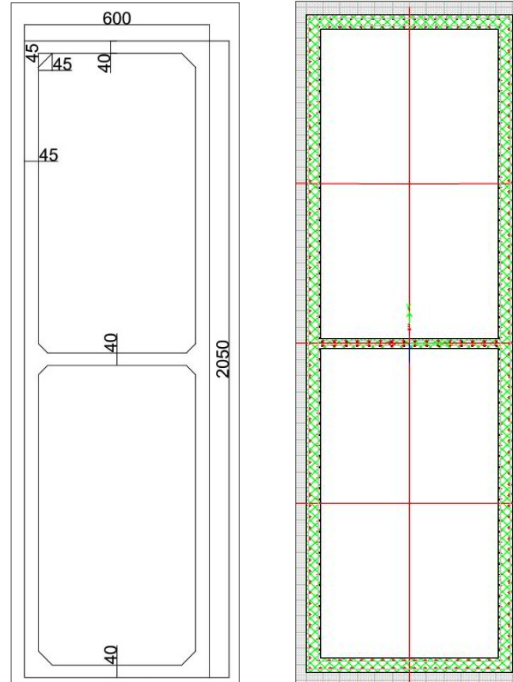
Dimensiones y distribución de refuerzo de la sección superior de la pila en el tramo atirantado.
